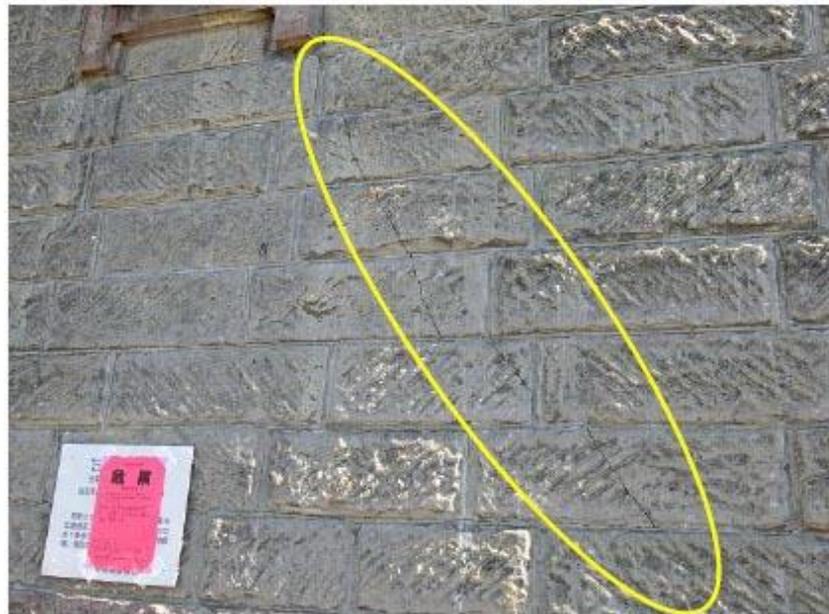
写真 5.3.19 前面のせん断ひび割れ
